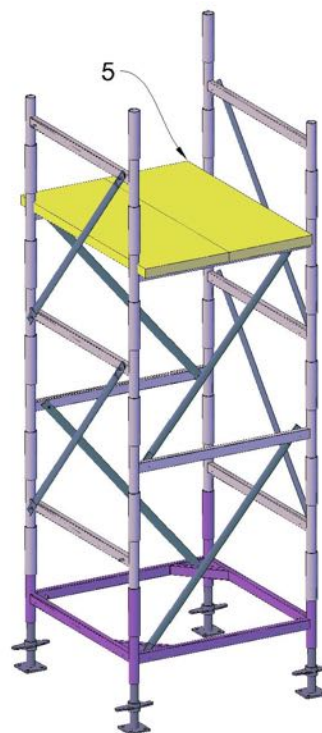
plancher en bois pour montages supérieurs aux 2,0 m
